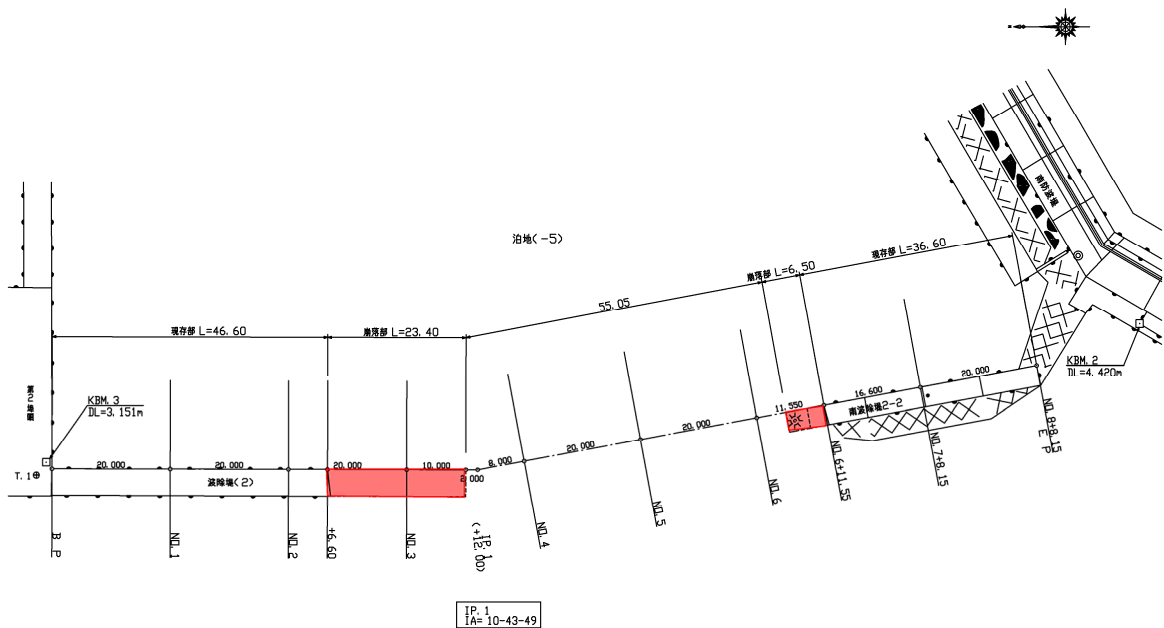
No.5 大洗港区\_北波除堤の平面図（被災後）
